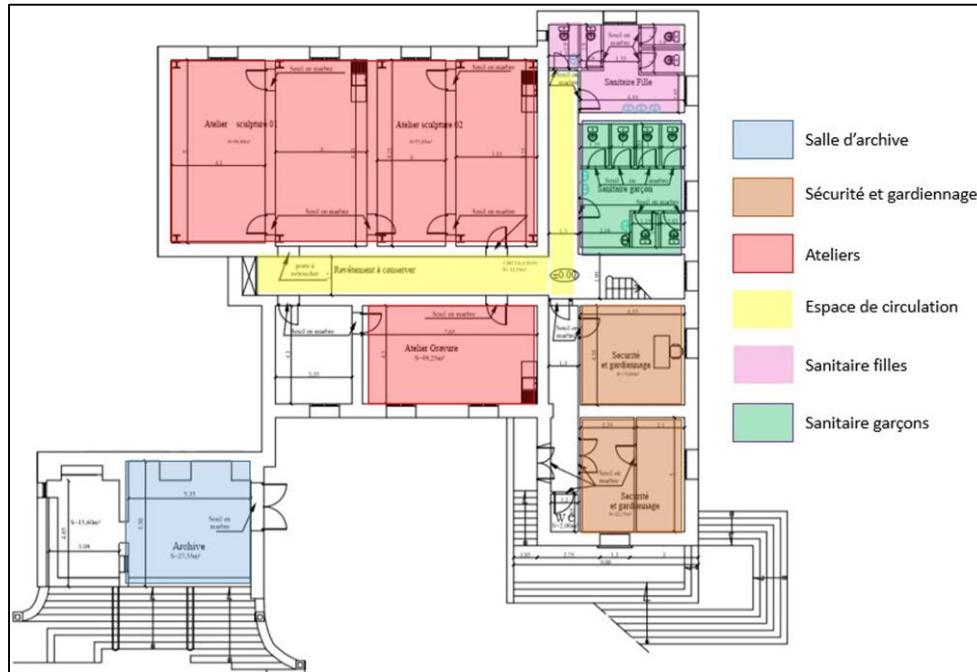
Plan de sous-sol (Fond : plan de la direction de l'urbanisme.
